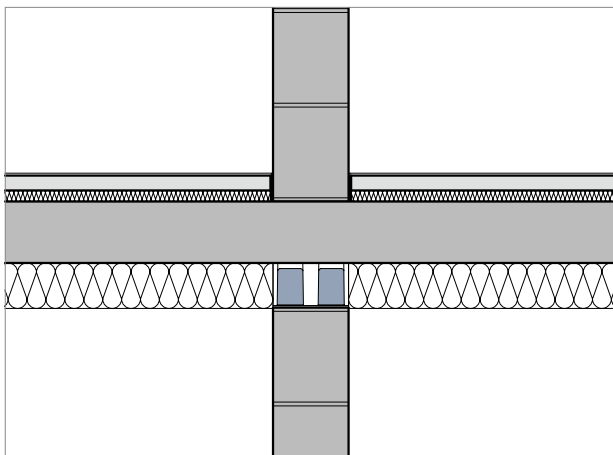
Schöck Sconnex® Typ M in Mauerwerk bei Innenwand und Unterdeckendämmung
